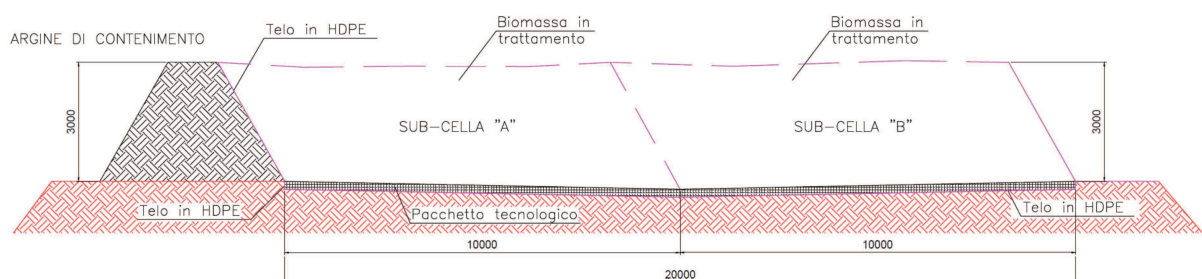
Sezione coltivazione tipo con suddivisione in due sub celle
